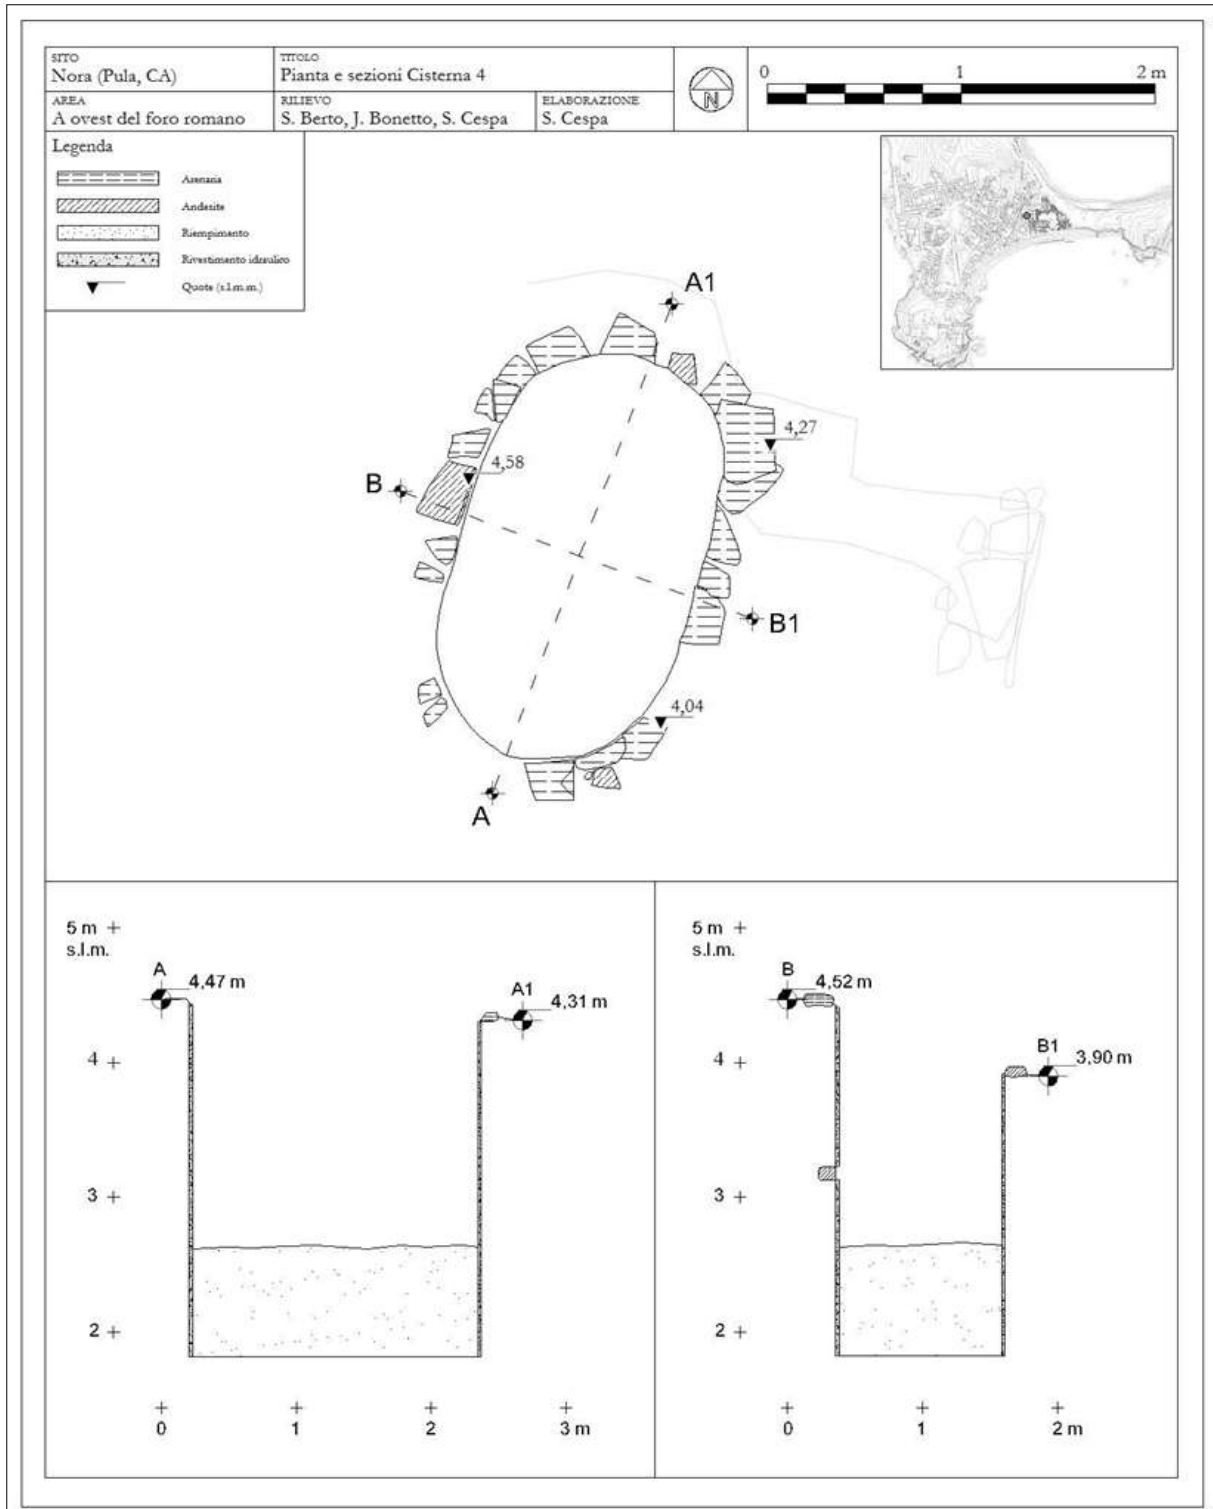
Pianta e sezioni della cisterna 4 (elaborazione dell'autore).
